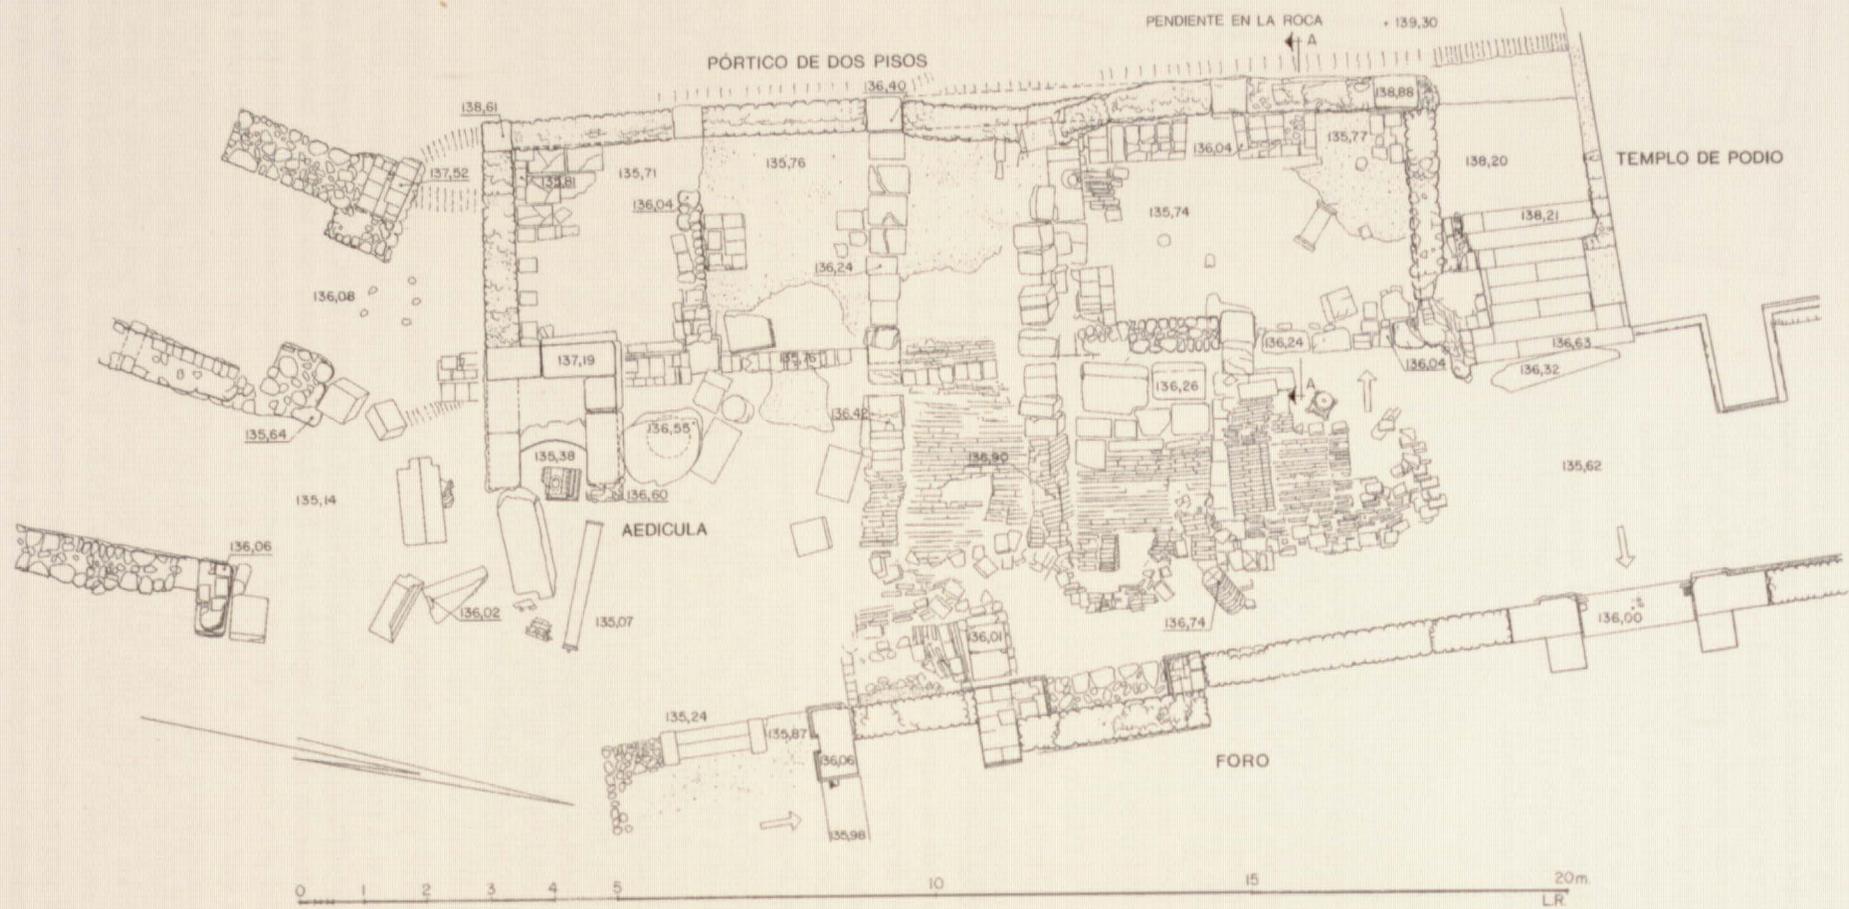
Pórtico de Dos Pisos y alrededores. Planta con la situación de la caída de los muros.
